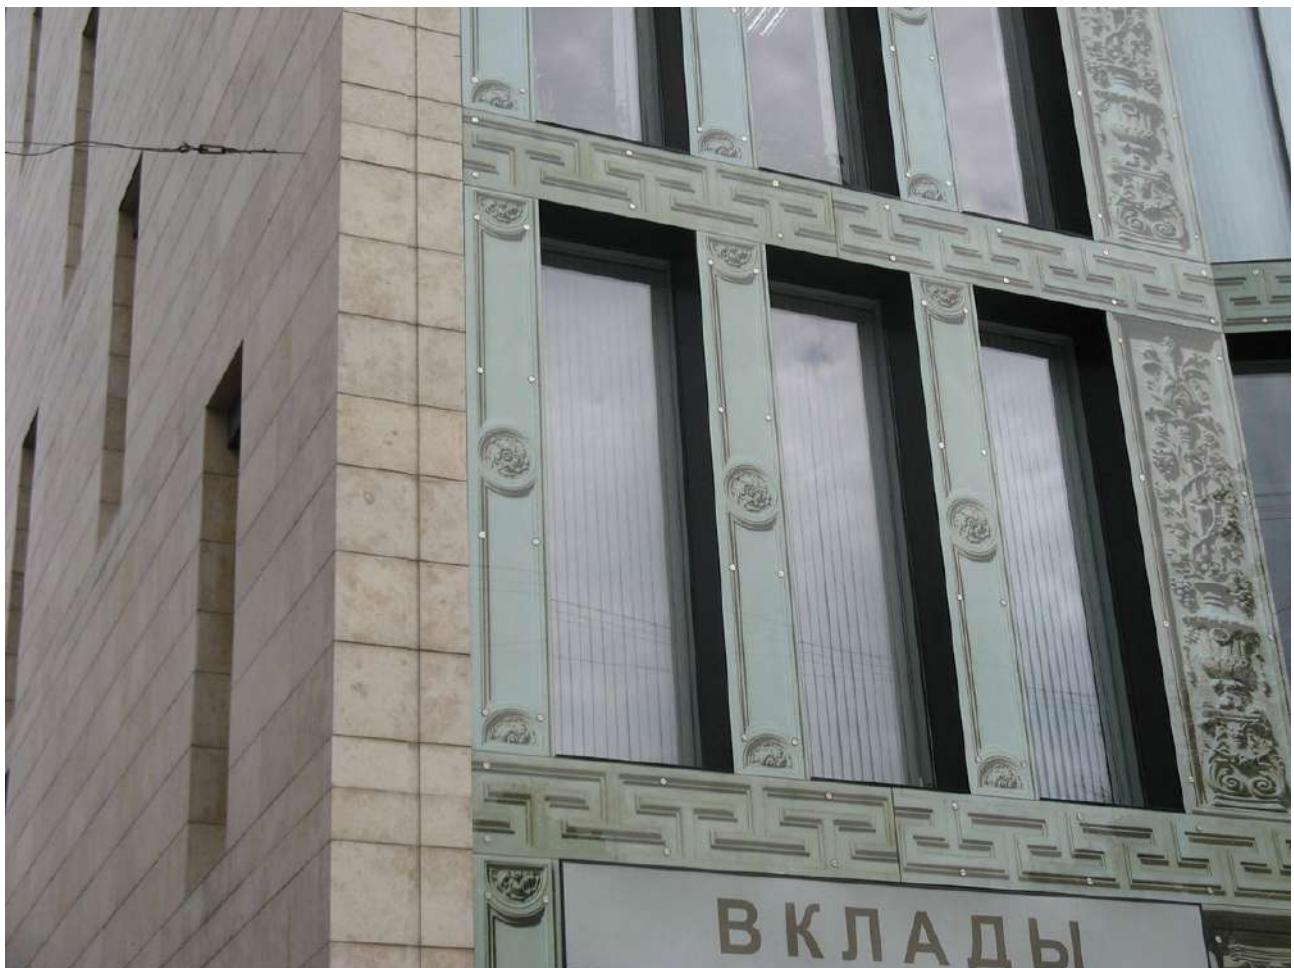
Фрагмент фасада с использованием стеклянных декоративных плит.
